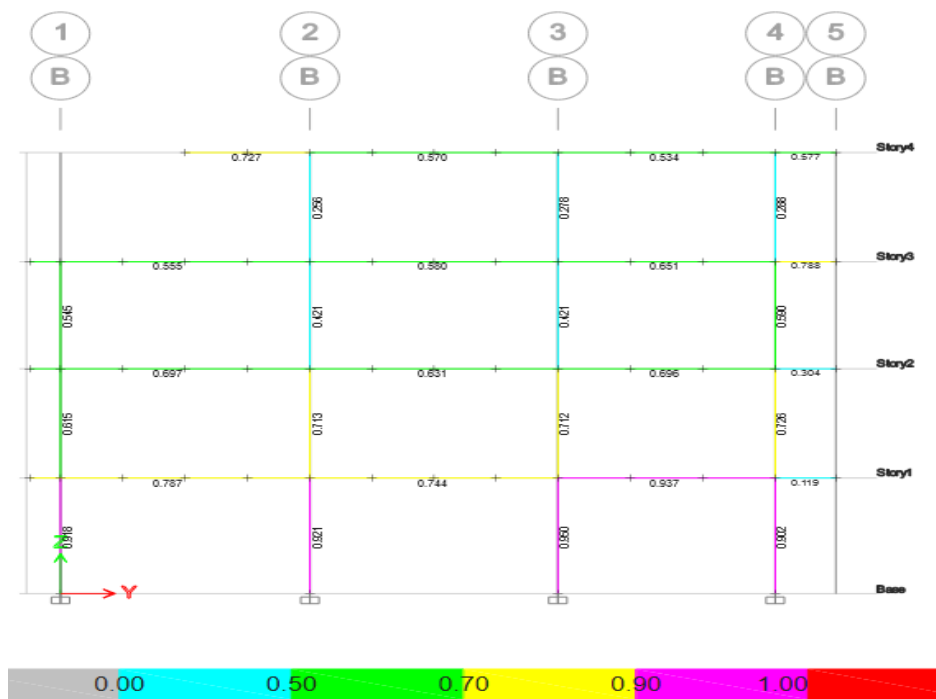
Vista en elevación eje B de secciones principales, con diseño AISC 360-16- demanda/capacidad
